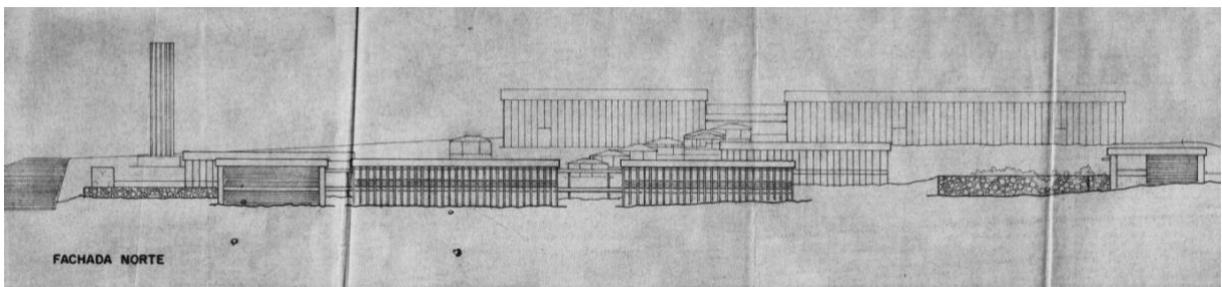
Fachada norte do conjunto industrial. Fonte: Arquivo da Secretaria de Obras da PMCG (2020).
